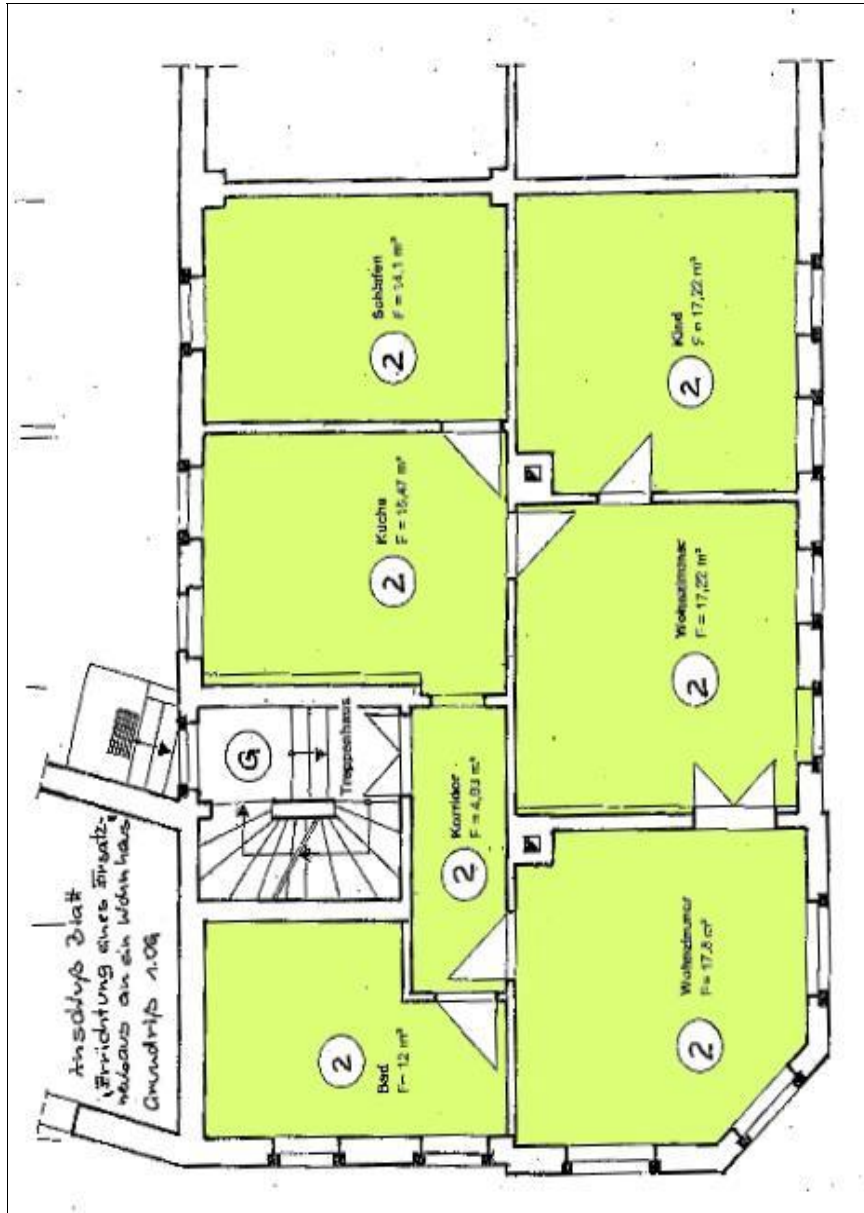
Grundriss des Wohnungseigentums Nr. 2
